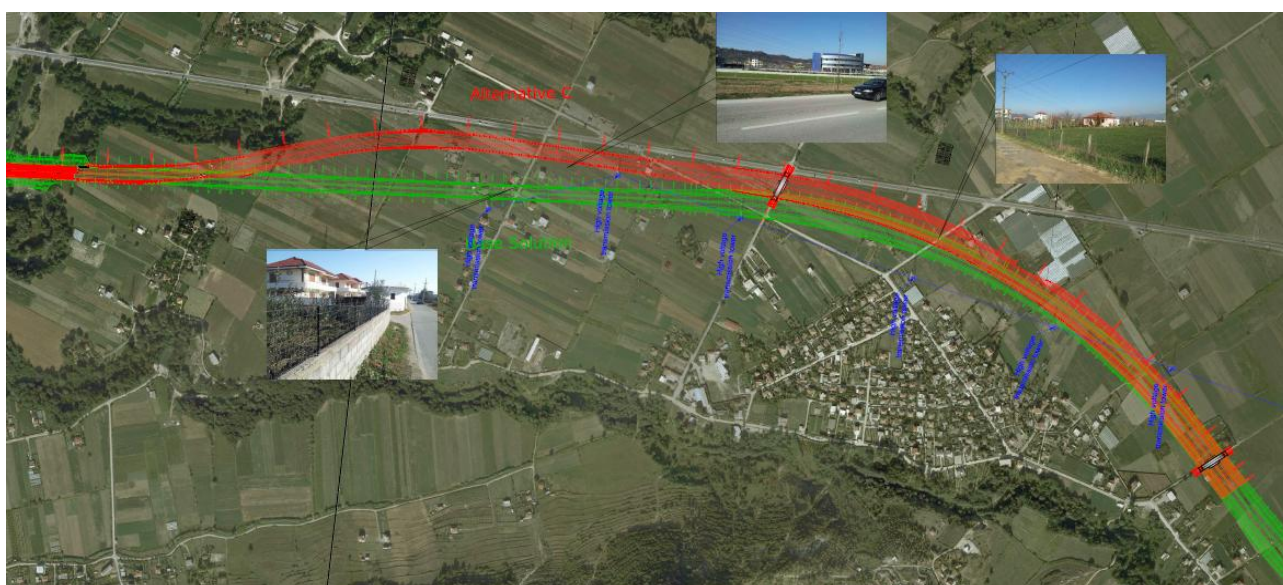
Alternativa C dhe zgjidhja baze – Planimetri
